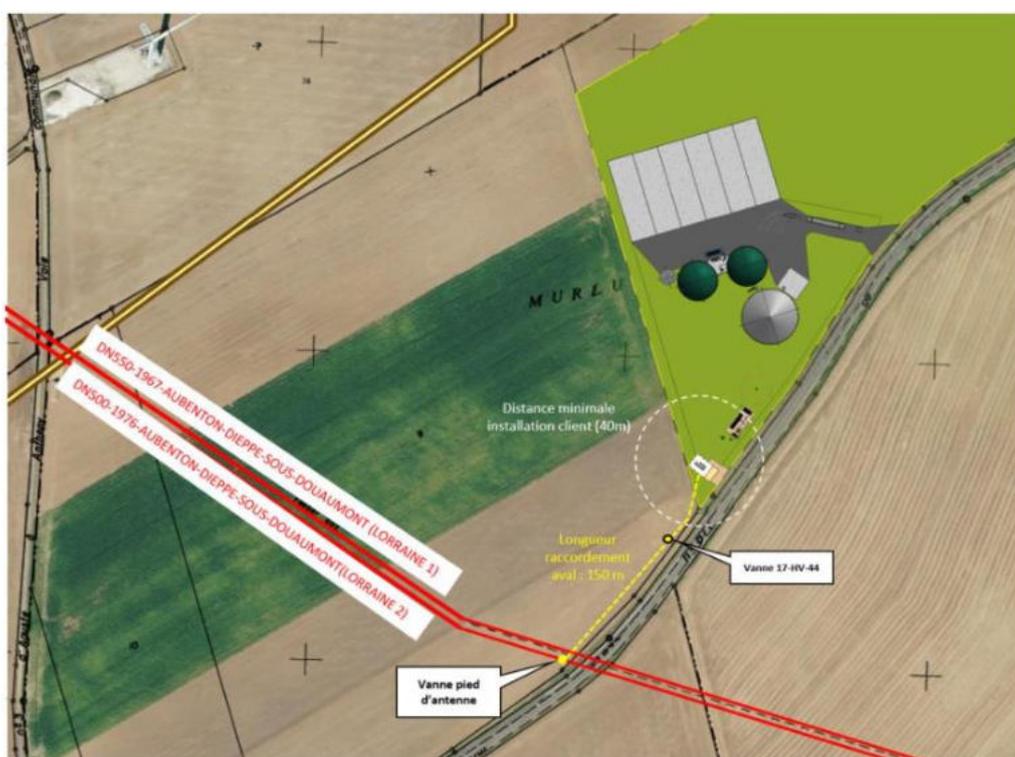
Plan d'implantation prévisionnel du Poste d'Injection
